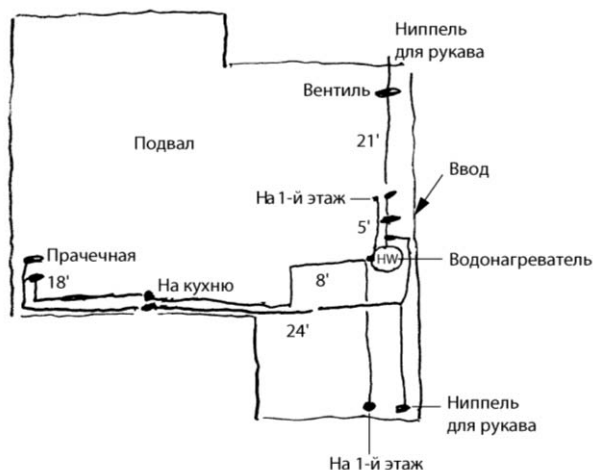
Схема трубопровода водоснабжения для каждого этажа
